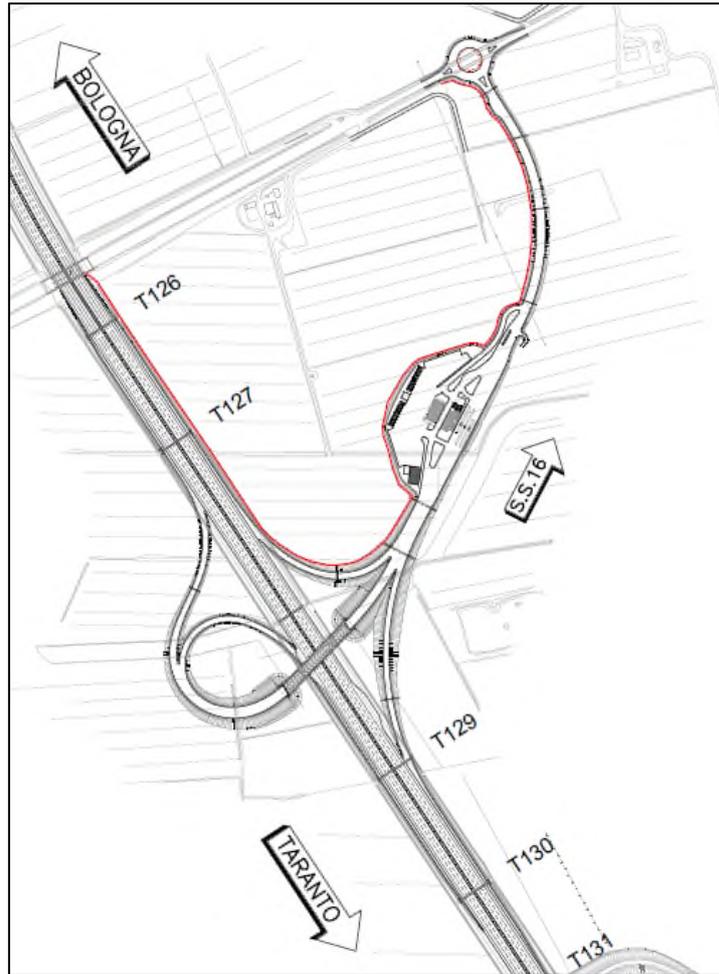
stralcio della planimetria di progetto con indicata in rosso la recinzione faunistica da prevedere in fase di Progetto Esecutivo
